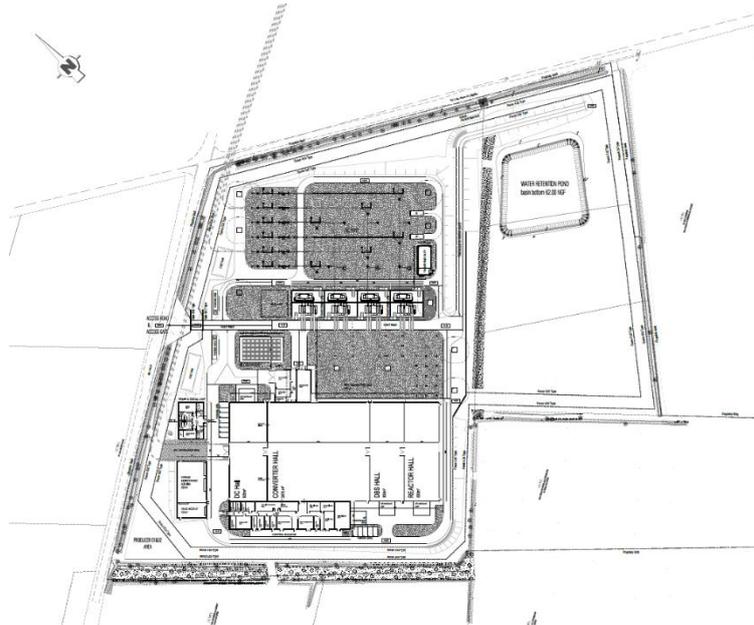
Plan de masse de principe de la station de conversion de Melleret (Source : RTE)
